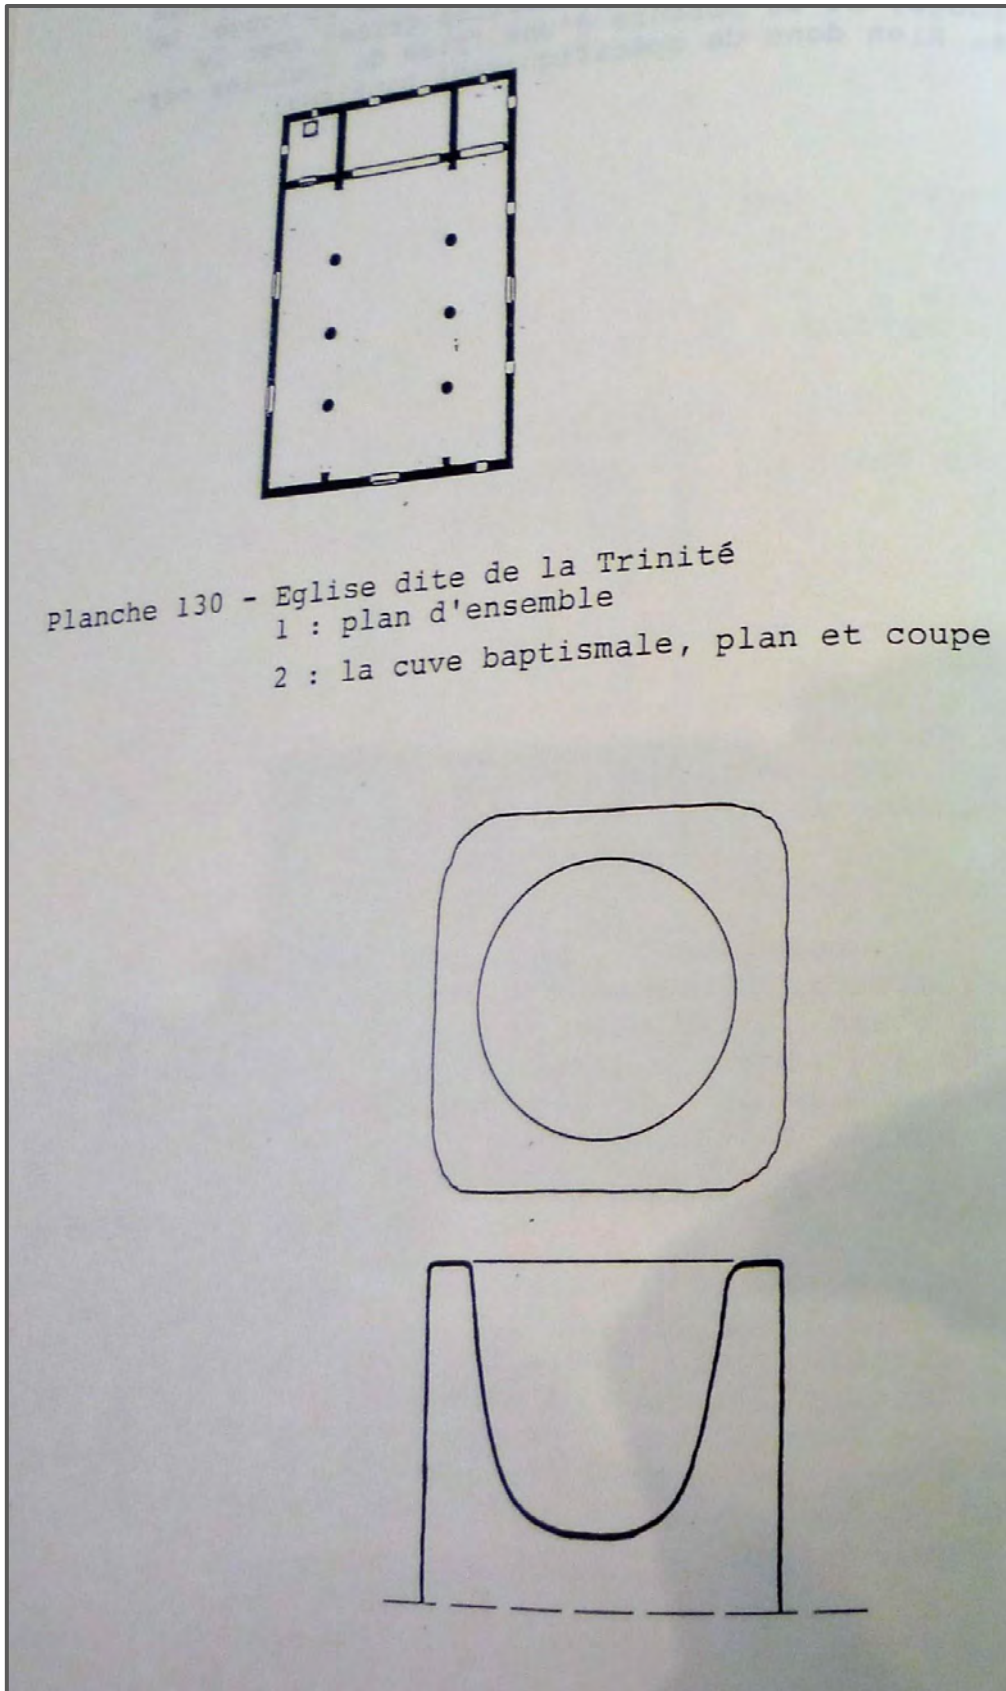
Dar Qita 3. Pianta del complesso, pianta e sezione del fonte battesimale
